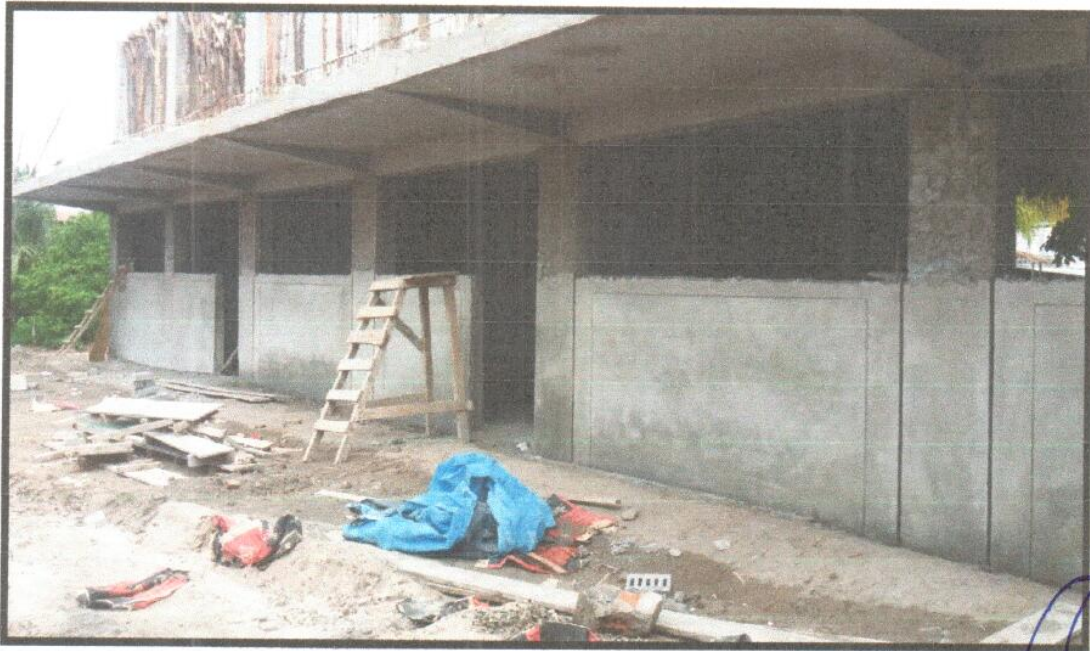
TARRAJEO EN MURO: EXTERIOR CON MORTERO. MODULO 03
